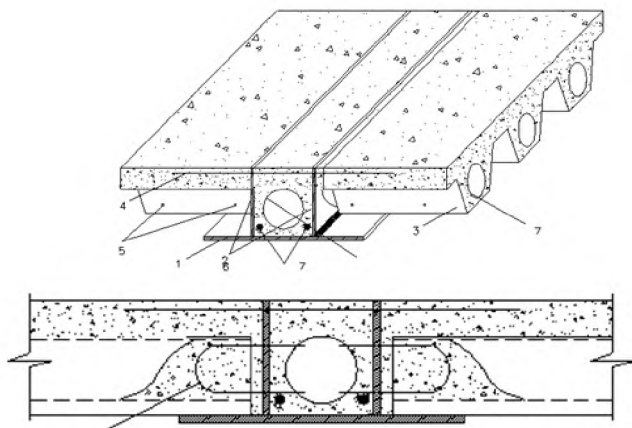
Сталобетонне перекриття з балок і плит ефективного перерізу: - нижній пояс сталевго ригеля, перфорована сталева стінка ригелю; 2 - порожнисто-ребриста плита ригелю, армована профнастилом; 3 - верхня надопорна арматура
